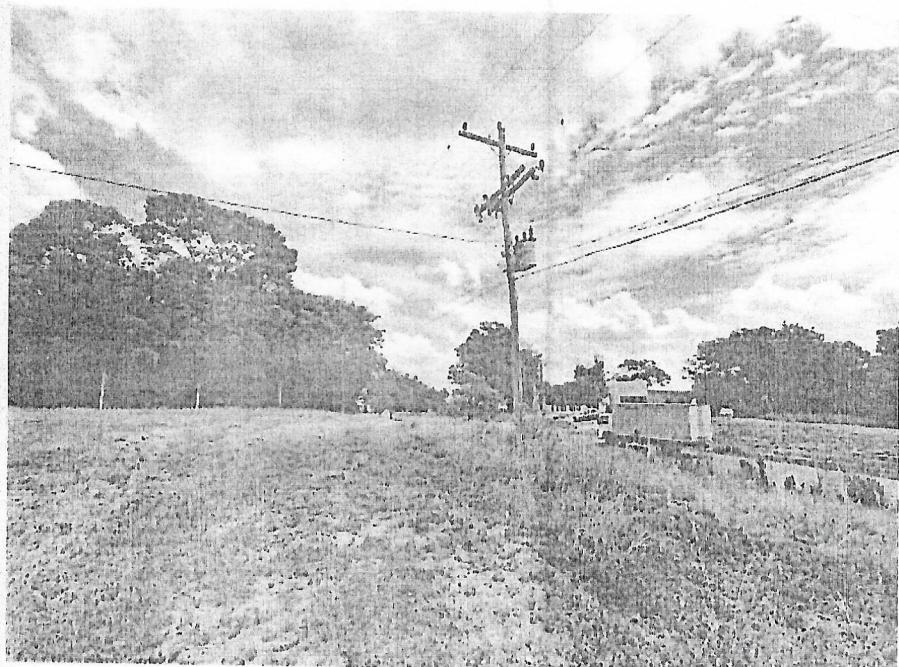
Visão aproximada do provável local de perfuração e instalação do poço em Hulha Negra, RS.
